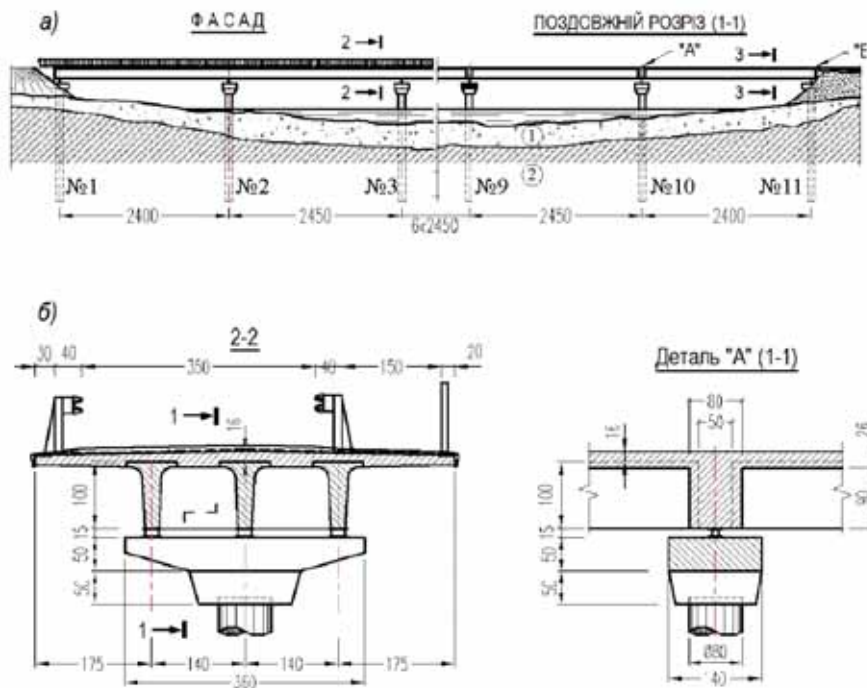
Конструкція моста з балково-нерозрізною прольотною будовою
